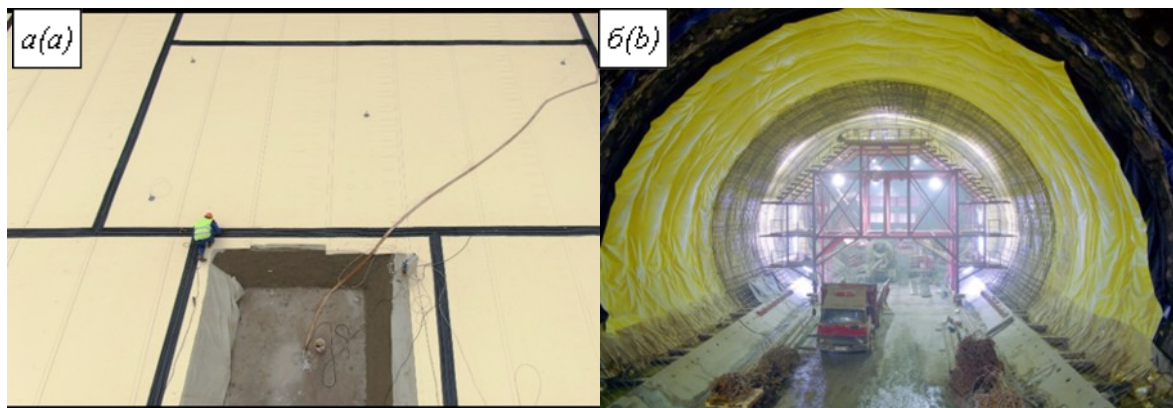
а – устройство однослойной ремонтпригодной системы гидроизоляции фундамента с ПВХ-мембраной и гидрошпонками; б – применение ПВХ-мембраны для гидроизоляции строящегося тоннеля метро
